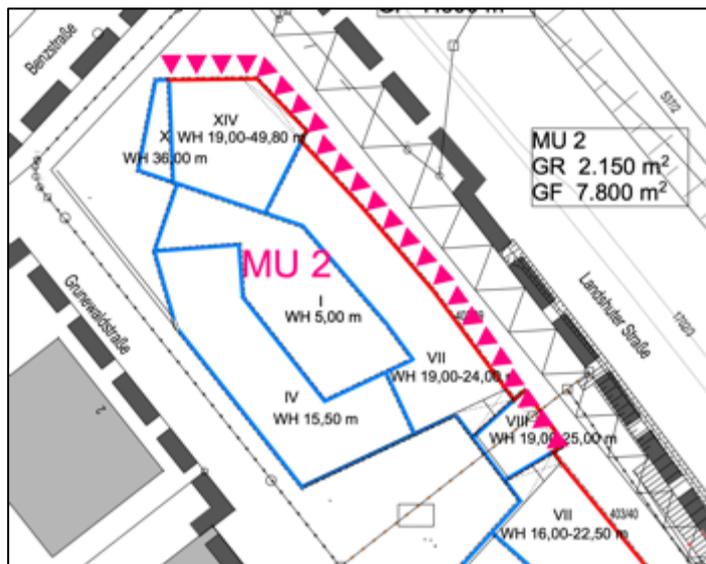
Plandarstellung zu Festsetzung § 15 Abs. 11
